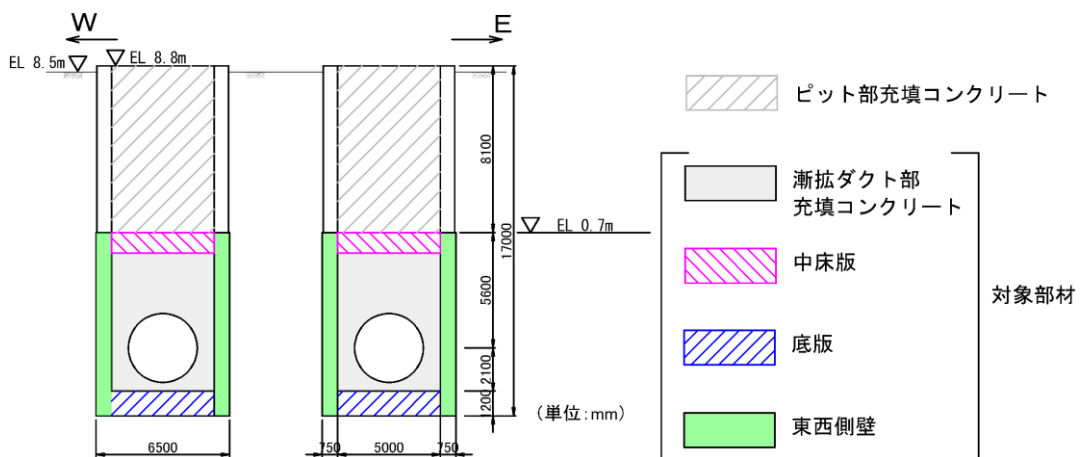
1号機取水槽評価対象断面図 (B-B断面)
